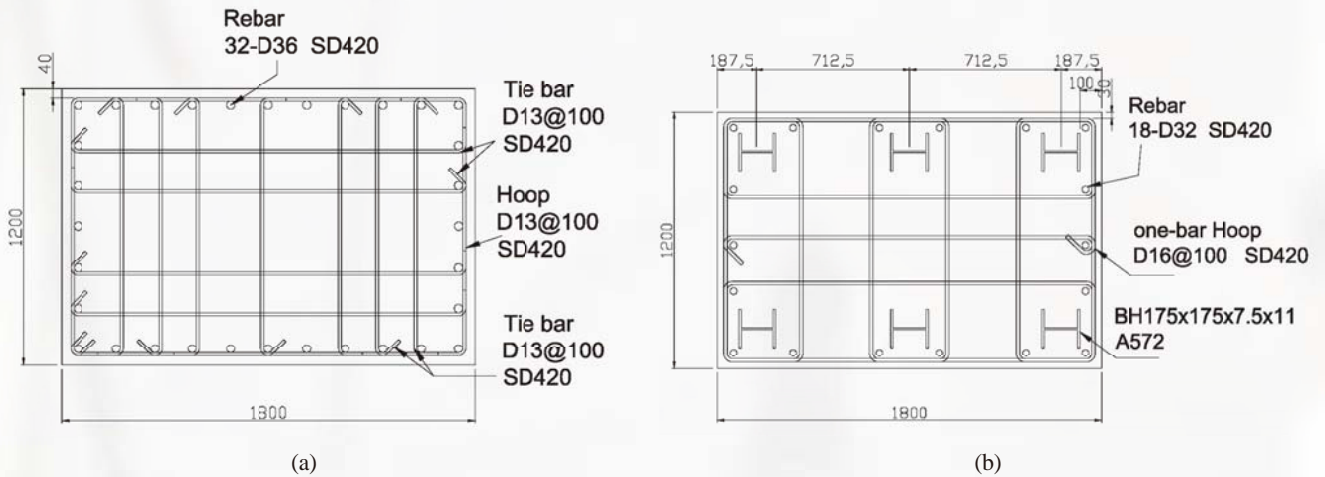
試體斷面配筋圖：(a) 傳統橋柱；(b) 鋼與混凝土複合式橋柱（單位：mm）
